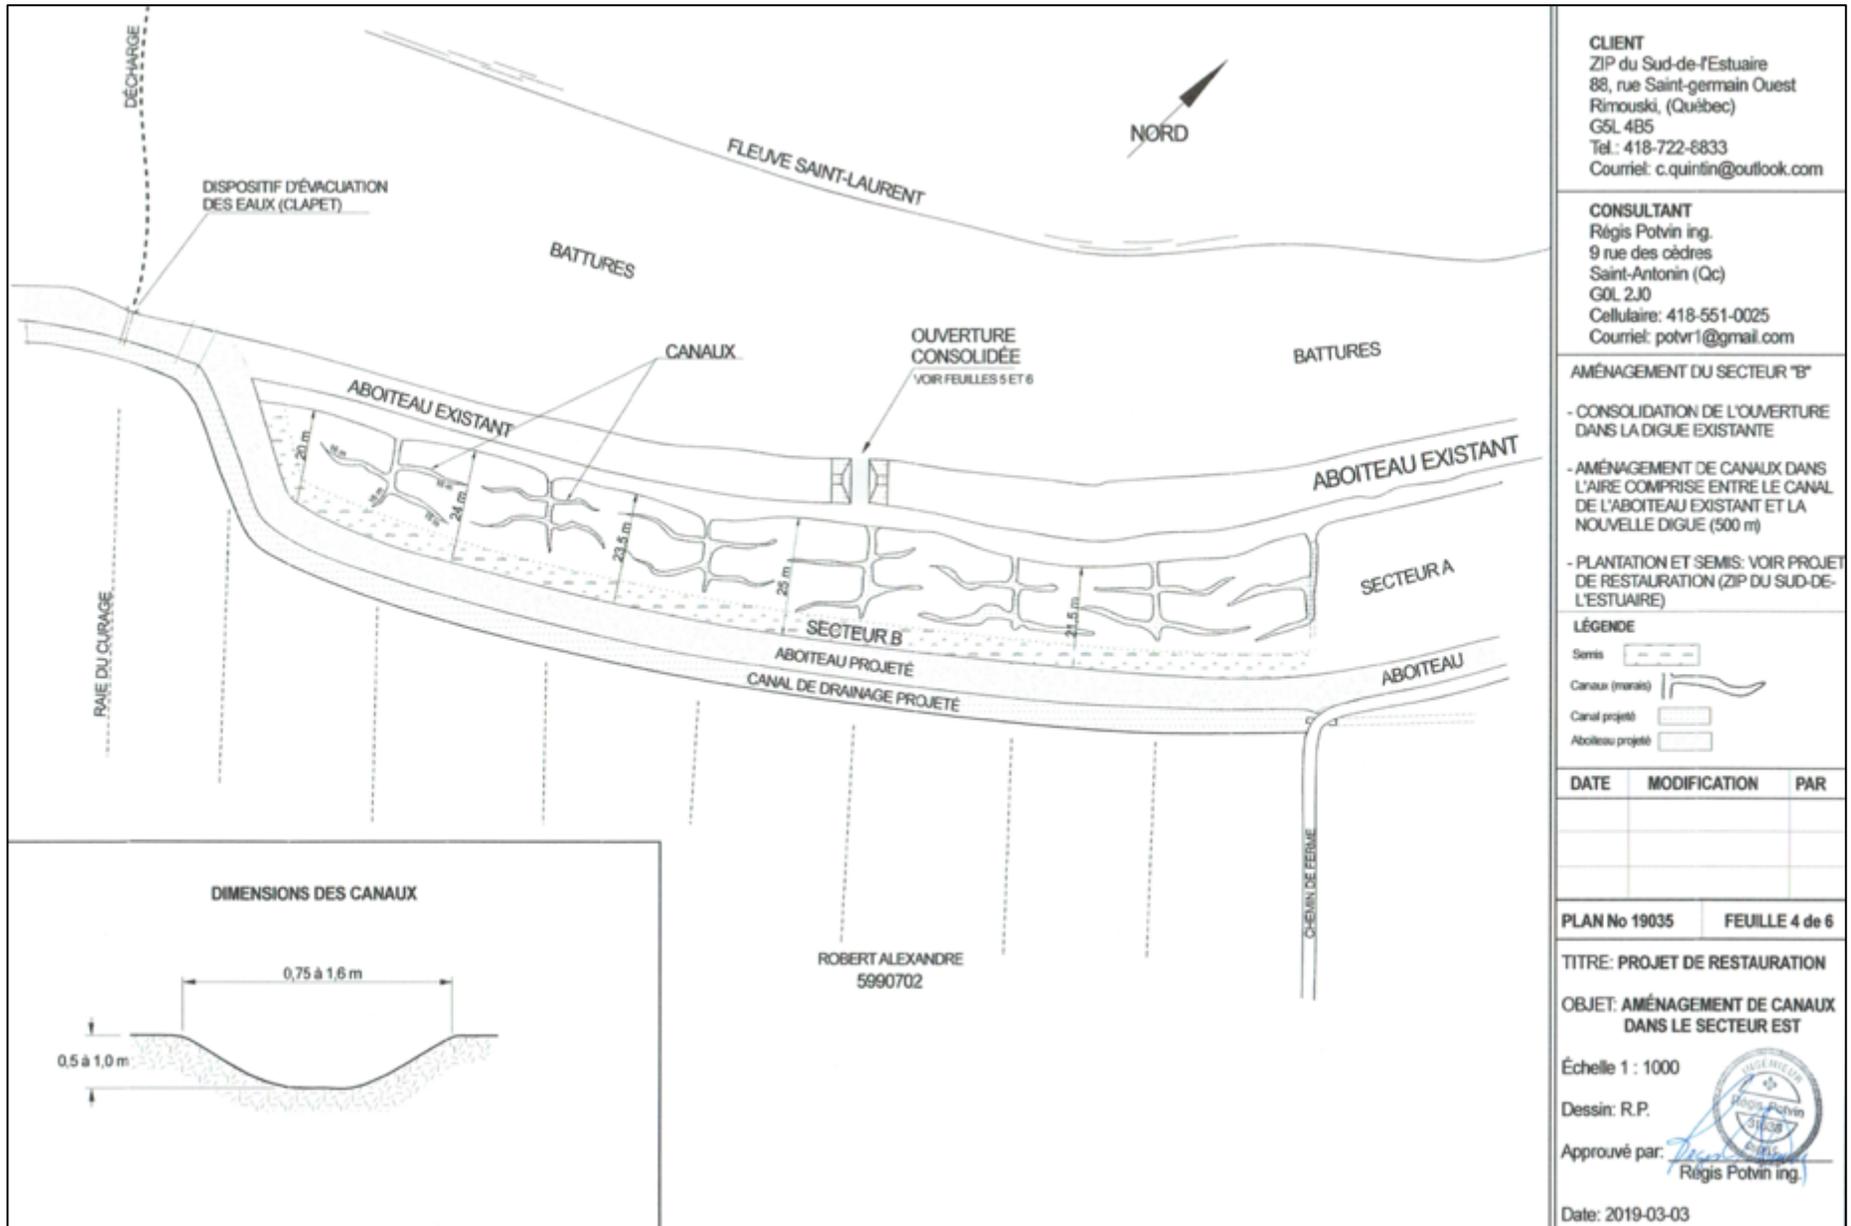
Plan 19035 feuille #4 - Aménagement des chenaux fauniques et de l'ouverture consolidée du marais reconstitué
